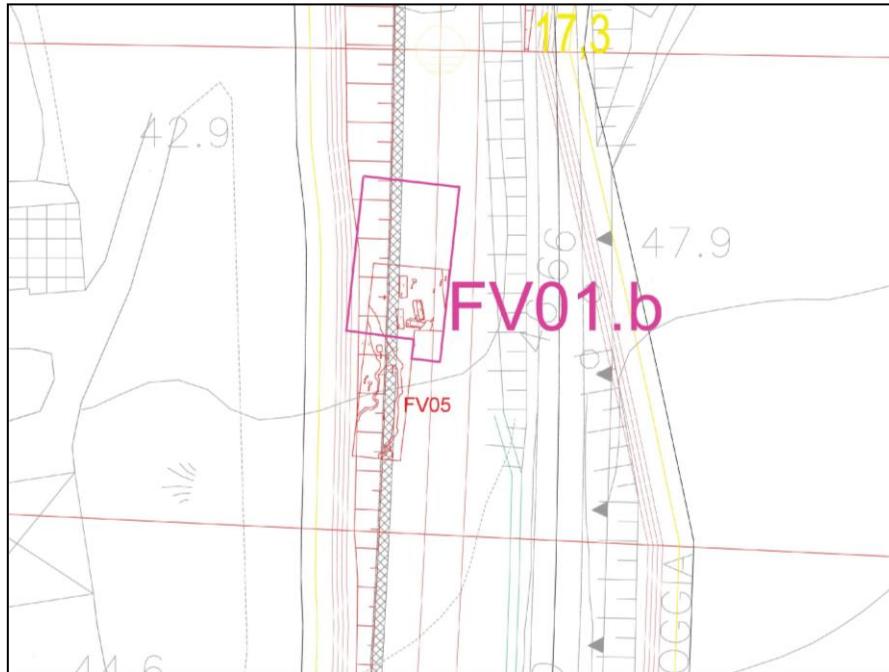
Stralcio planimetrico con l'area di estensione dello scavo di seconda fase di FV01b
